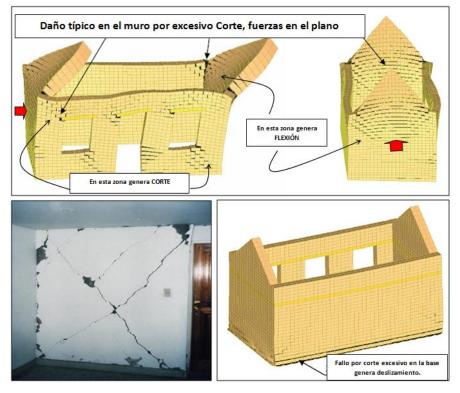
Daño típico en un muro no estructural por Corte en X y deslizamiento del muro en la base. Fuente: Artículo sobre Terremoto predicción de respuesta. Zengyan Hiroyuki Watanabe. Canadá, Agosto 2004
